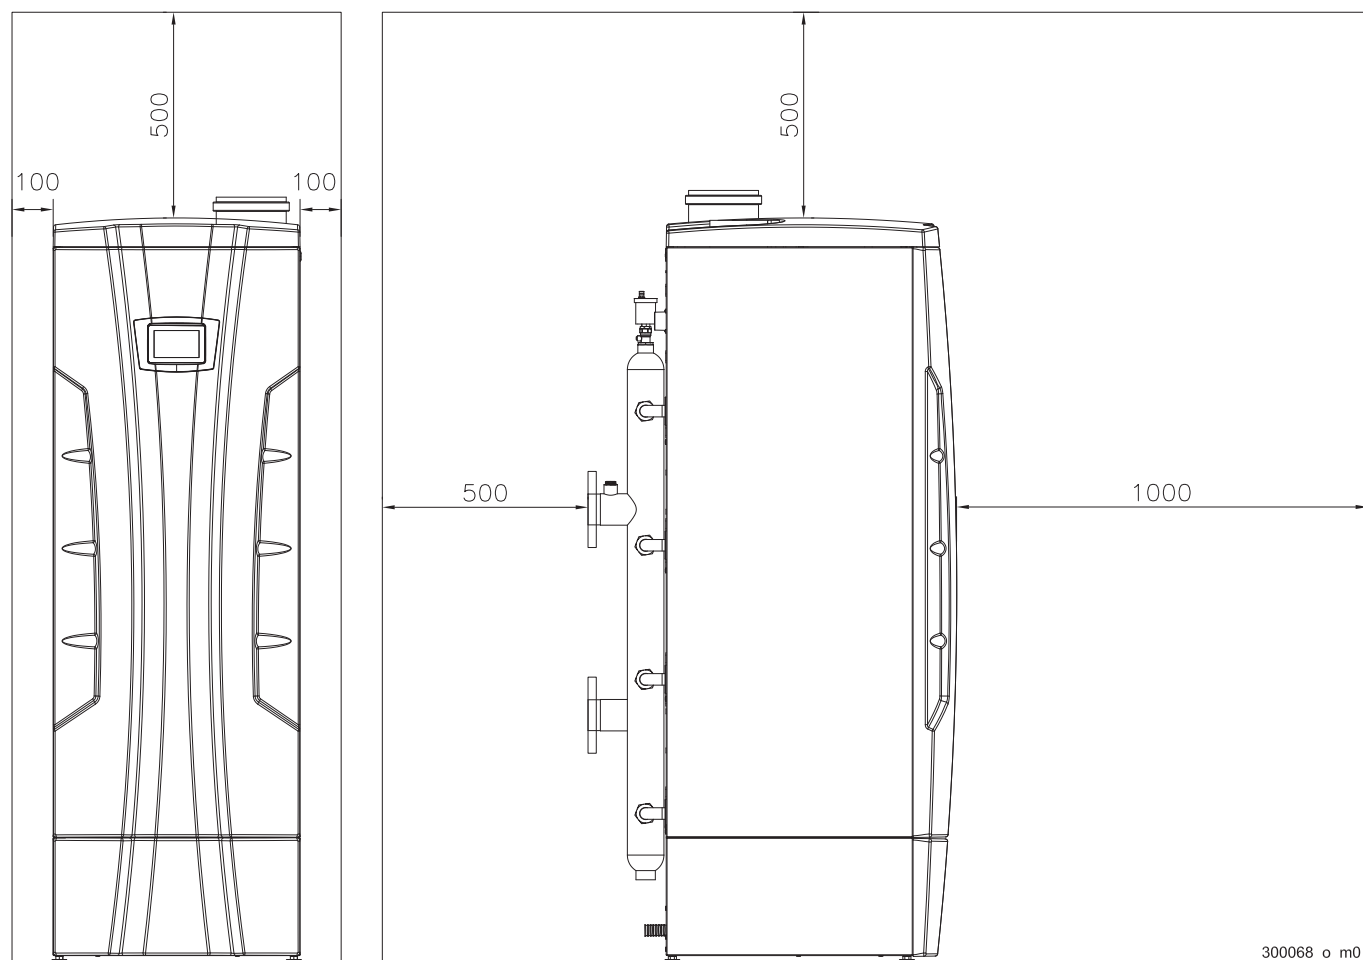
Distanze minime di rispetto modelli 180-210-280
